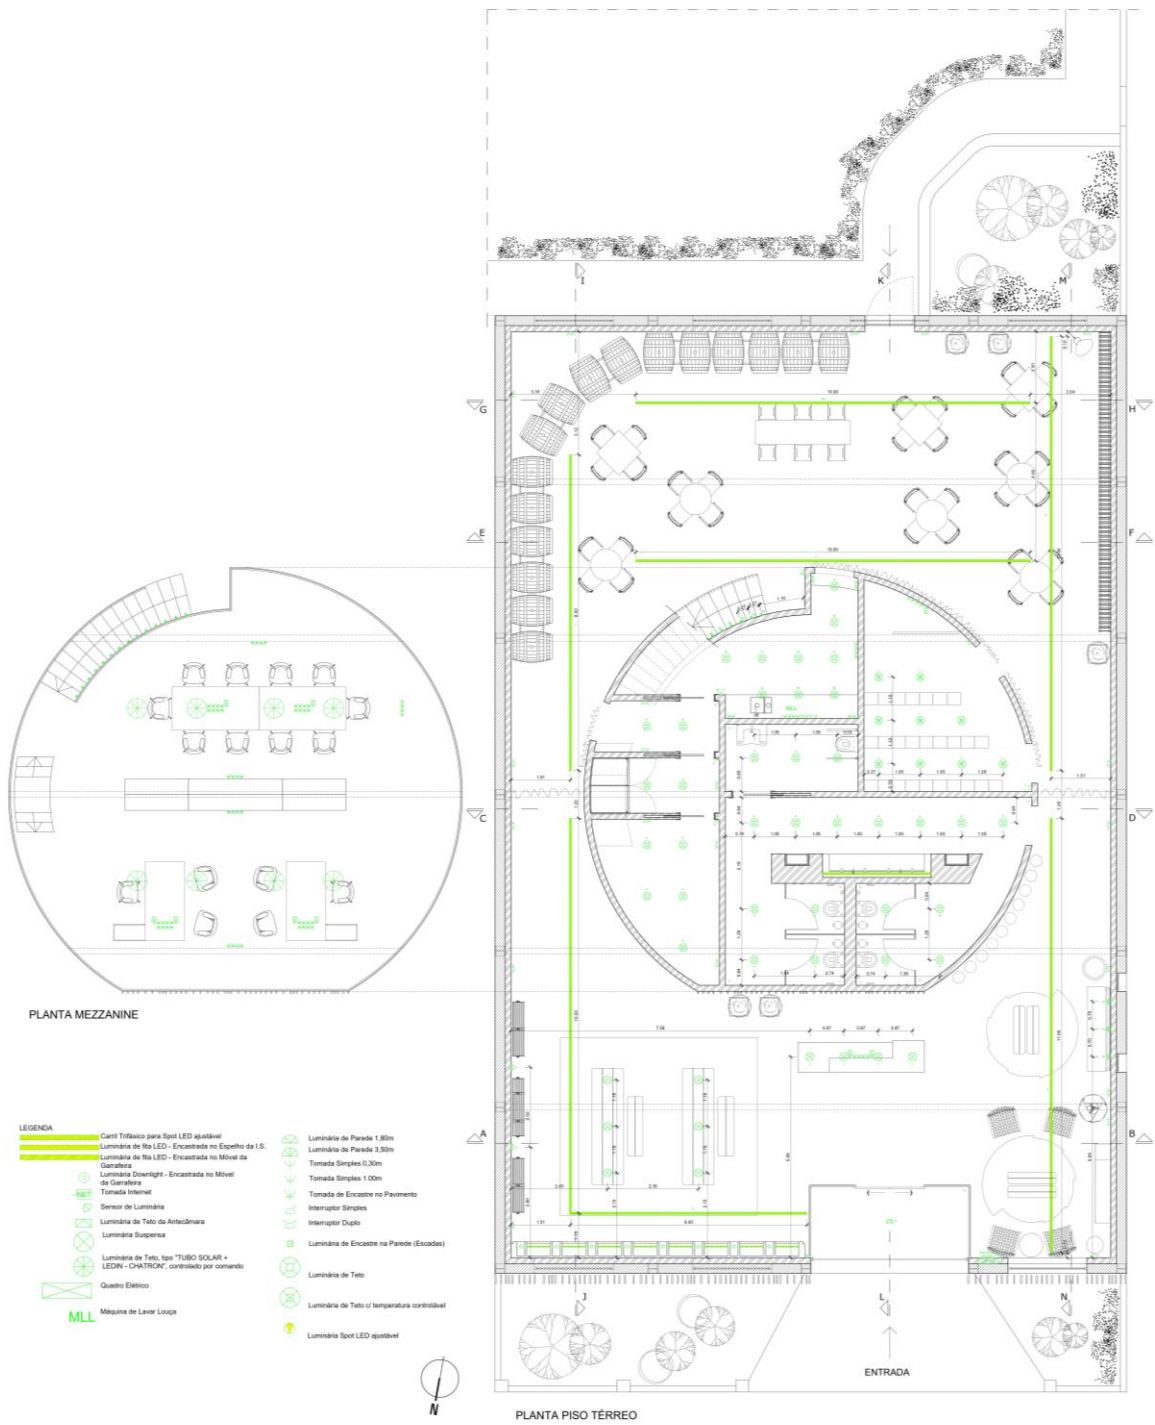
Desenho Técnico - Planta de Iluminação. Fonte: (Autor)
